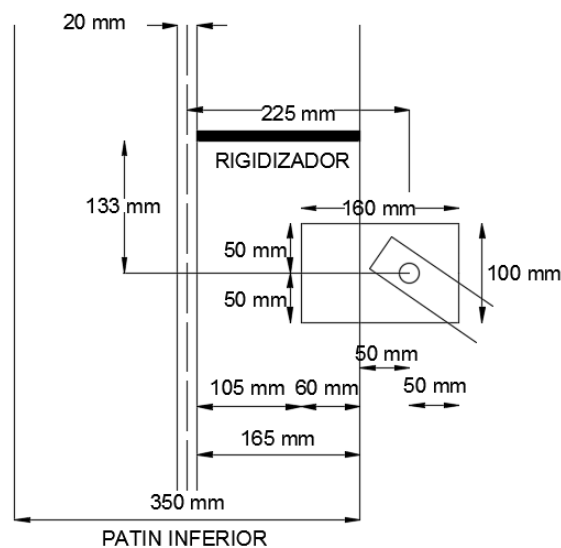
Dimensiones de la placa metálica y su localización. Realizado por: Autor
